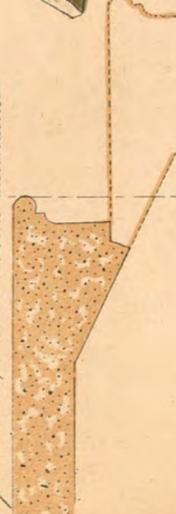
La sezione verticale di porzione del pianerottolo, tra le due rambe
